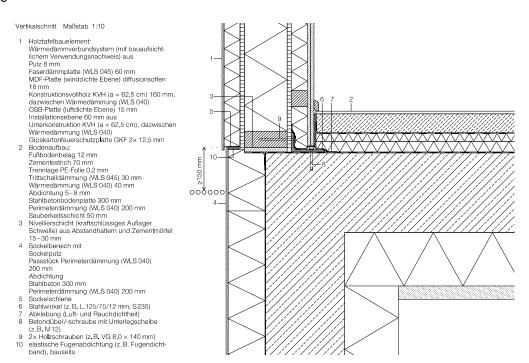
Prinzipskizze: Anschlussdetail einer Bodenplatte aus Stahlbeton zu einer Fassade in Holztafelbauweise [11]
